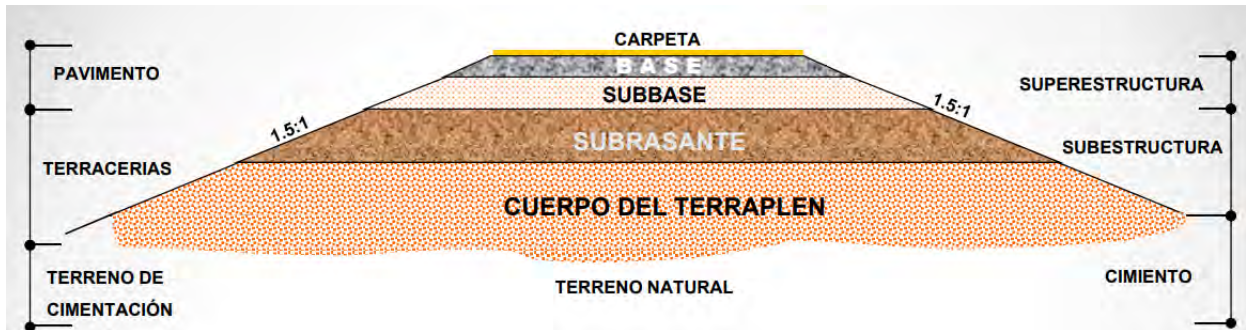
Estructura de una carretera con pavimento flexible (Reyes R. R., 2020).
